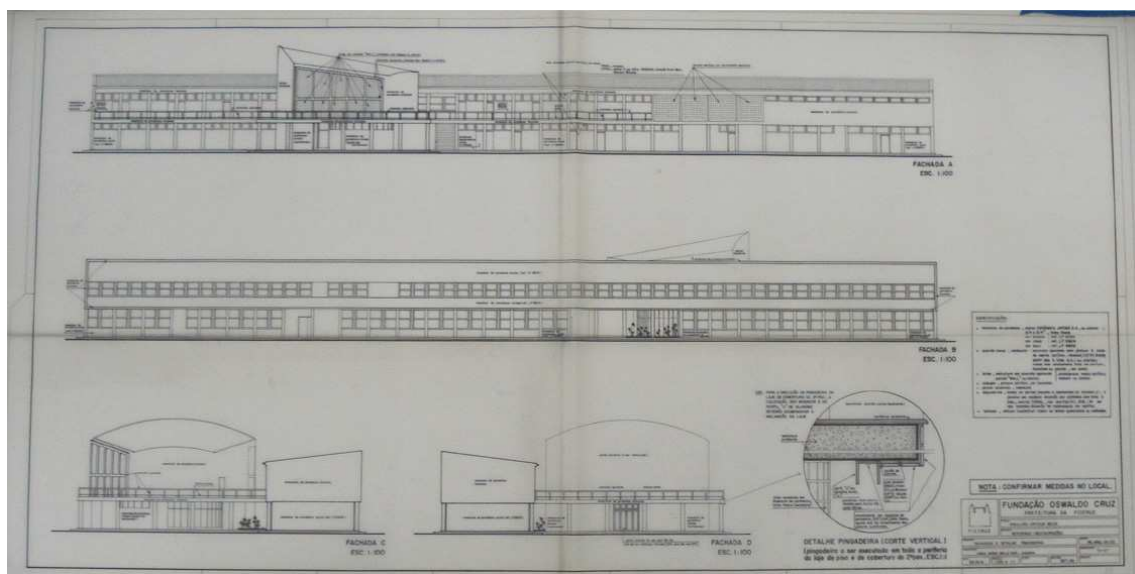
Projeto de reforma do Pavilhão de Cursos – Fachadas. 1991. Acervo DAD/COG.
